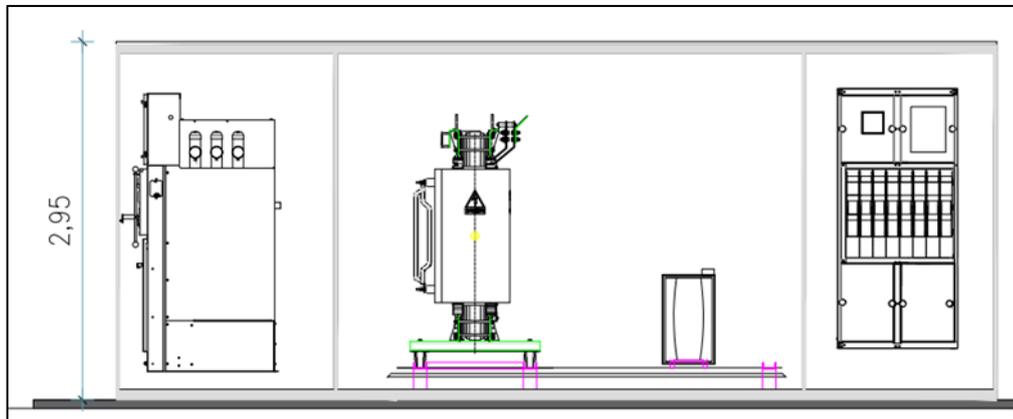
Planimetria (esempio) cabina di Trasformazione (cabina di campo) – vista in sezione
